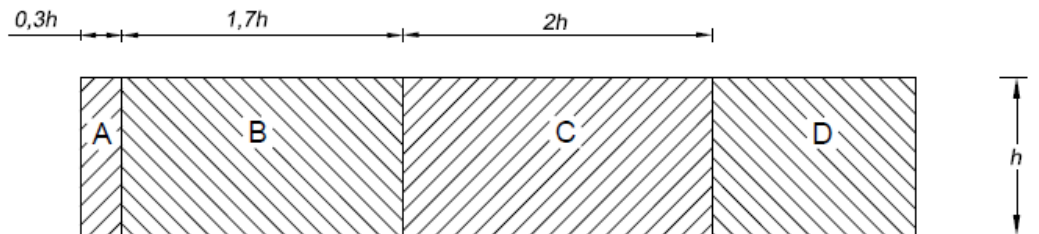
Suddivisione di muri e parapetti in aree di uguale pressione complessiva
